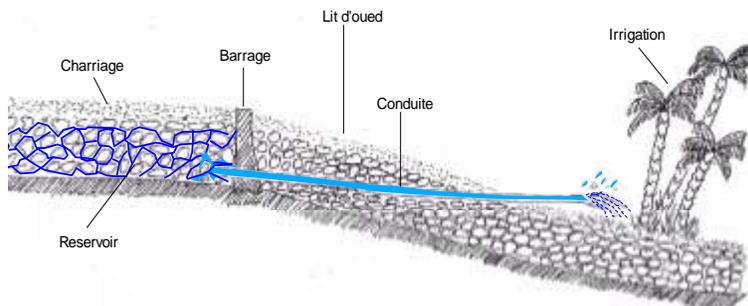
Schéma d'un barrage Inferoflux équipé d'une conduite souterraine (Schéma, Remini, 2020)
